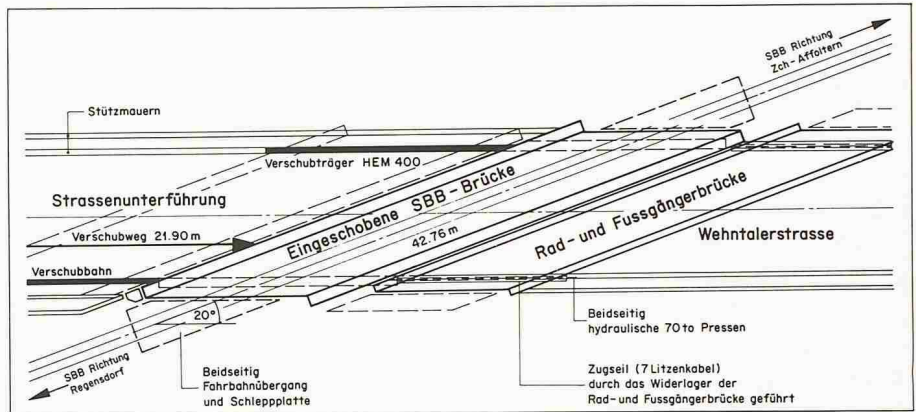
Grundriss Unterführung Wehntalerstrasse
